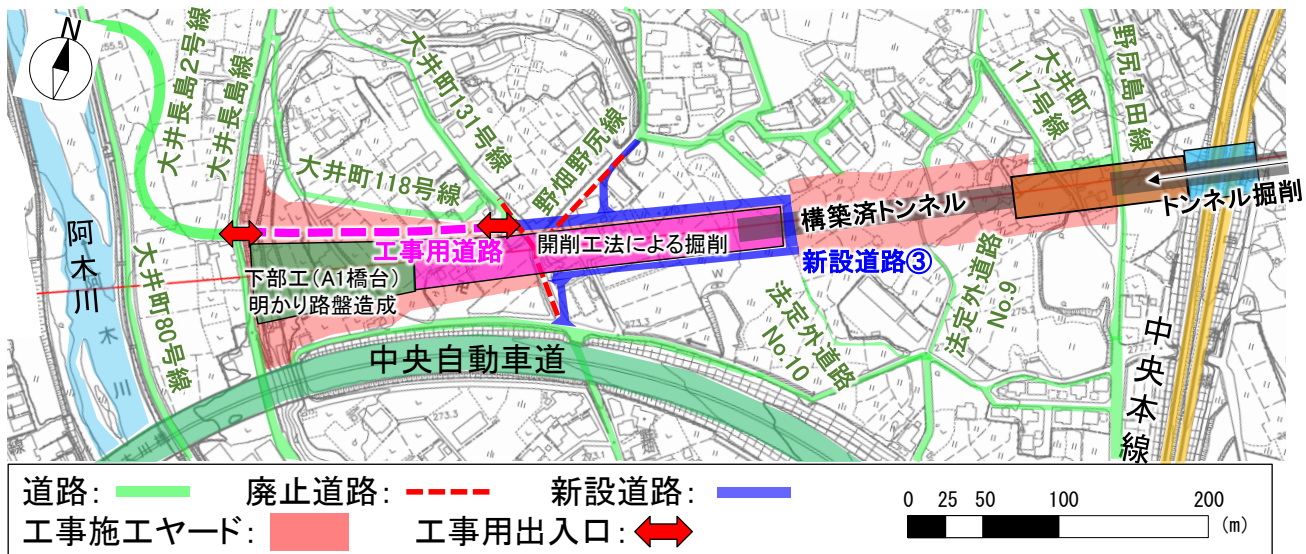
名古屋方工事施工ヤード（東側施工時）の平面図
